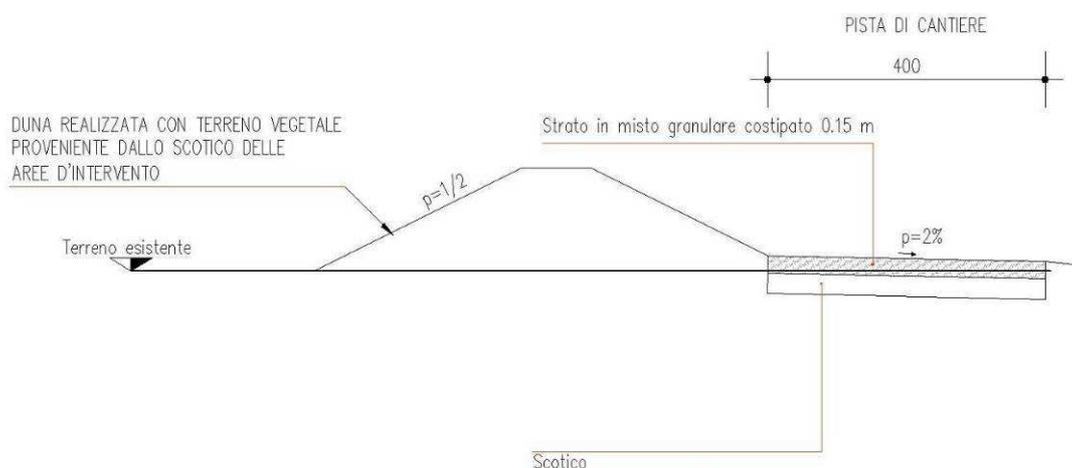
SEZIONE TIPO DELLE PISTE DI CANTIERE (ESTRATTO DALL'ELAB. PD_1_D03_DKK00_0_KK_FS_01-TAV. 10)
